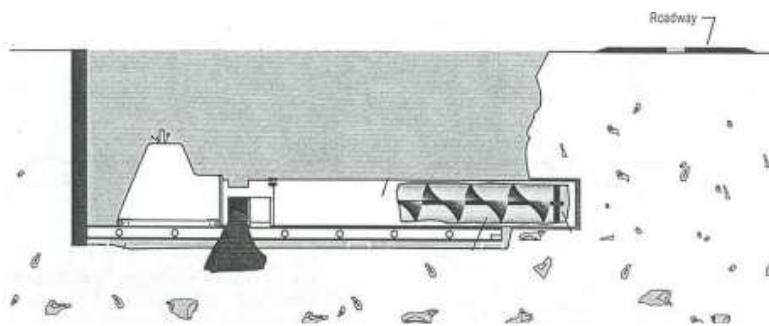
Esquema de perforación Auger Boring. Fuente: <http://rebar.ecn.purdue.edu/Trenchless/Pics/AB/AB-Track%20Type%20AB.jpg>
